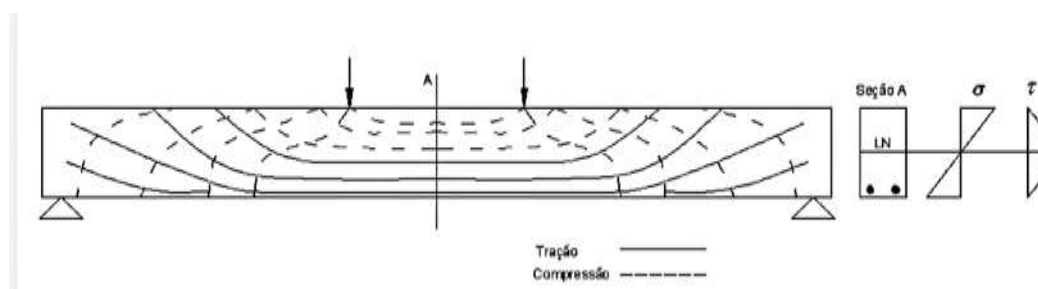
Tensões principais em vigas não fissuradas sob flexão
